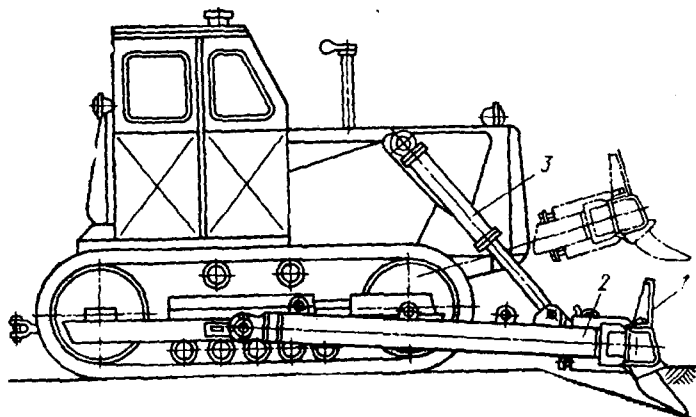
Корчеватель с передней навеской рабочего оборудования:
